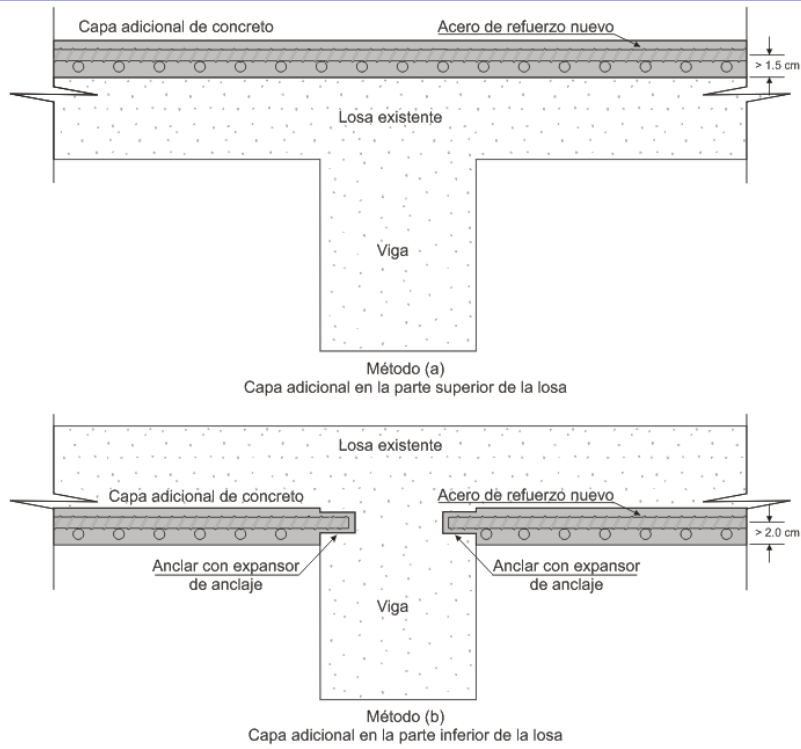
Reforzamiento de losas mediante capas adicionales de concreto.
